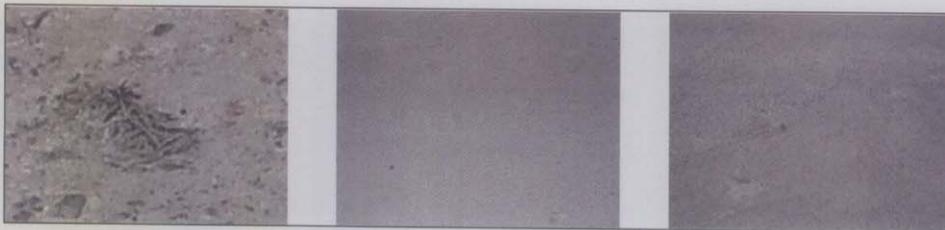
Estado de la carpeta de desgaste en servicio en puente sobre A° Los Pozos. Izquierda: aparición de un "erizo" de fibras en el sector con hormigón S3, centro: fisura en la junta constructiva entre dos sectores con hormigón N1 hormigonados por separado, derecha: fisuras en carpeta de losa de aproximación sin fibras.
